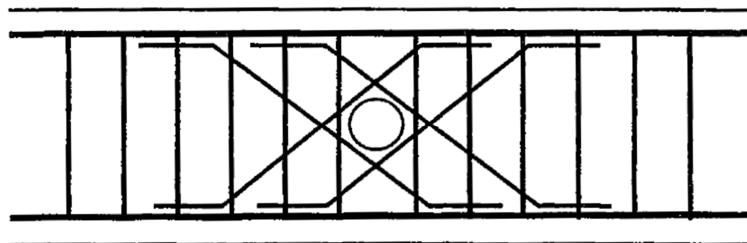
Armadura adicional na zona das aberturas – segundo Mansur e Tan (1999).
